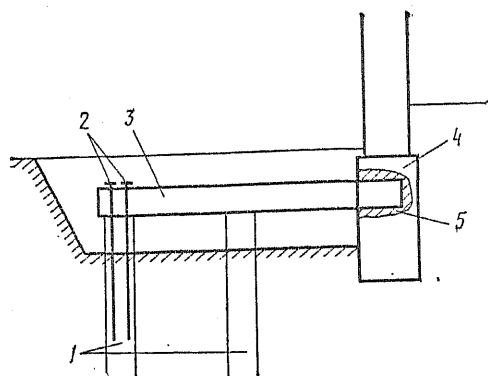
Усиление фундамента буронабивными сваями, расположенными снаружи здания
